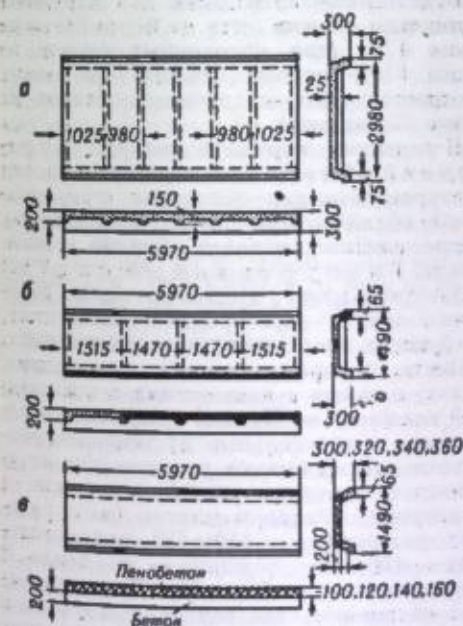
Крупнопанельные плиты покрытий при шаге колонн 6 м: а — размером 6 м × 3 м; б — размером 6 м × 1,5 м; в — конструктивная арматура плиты из ячеистого бетона и ребрами из тяжелого железобетона.
